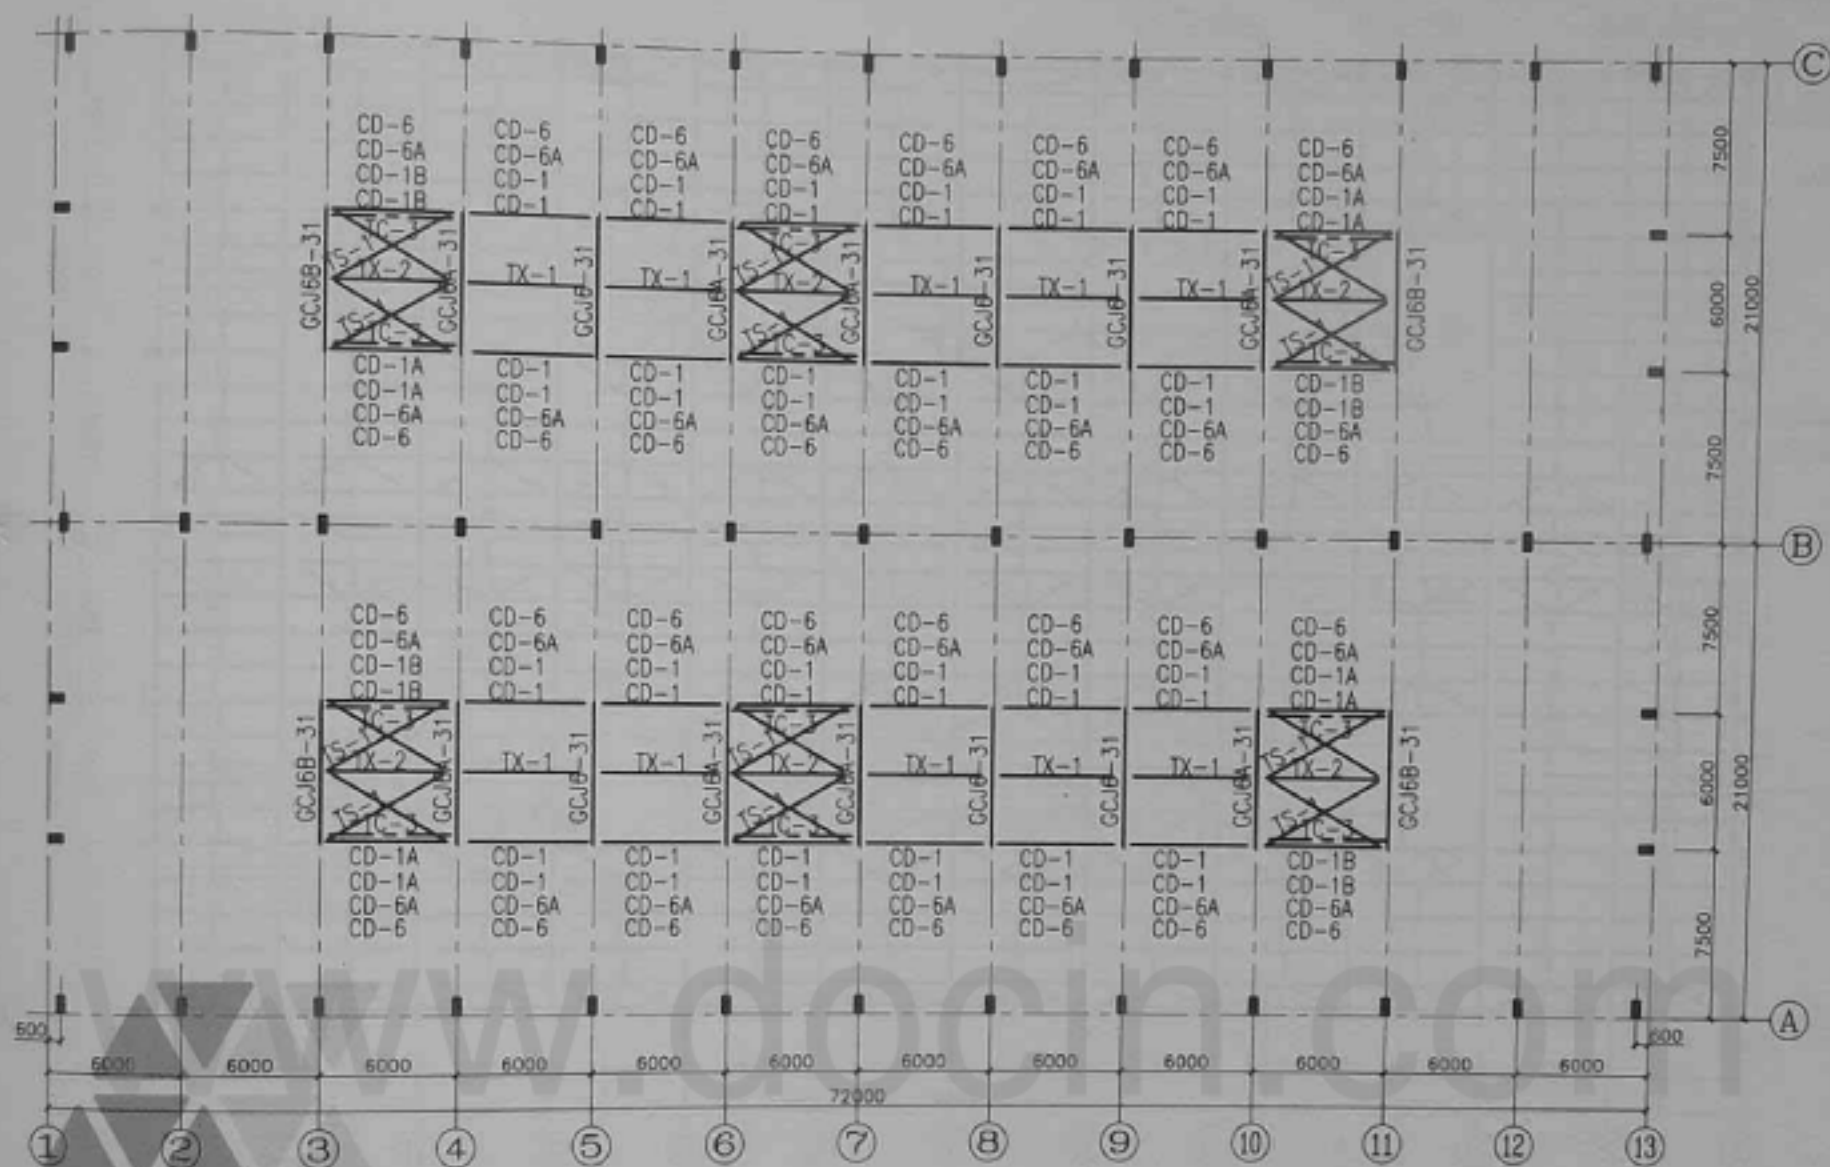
钢天窗架、横向支撑、竖向支撑及窗档平面布置图
